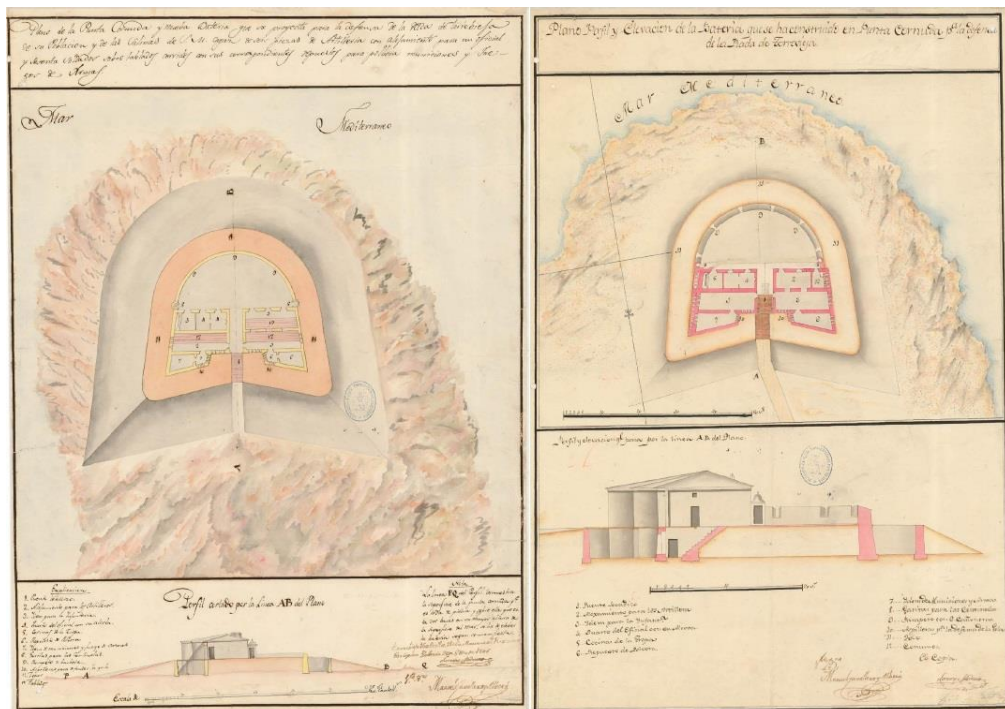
Batería de Punta Cornuda: proyectada (plano 15) y construida (plano 18).
